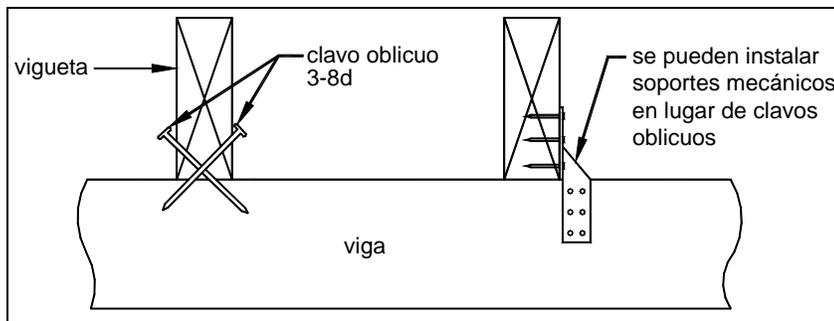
DETALLE DE LA UNIÓN DE LA VIGUETA CON LA VIGA
